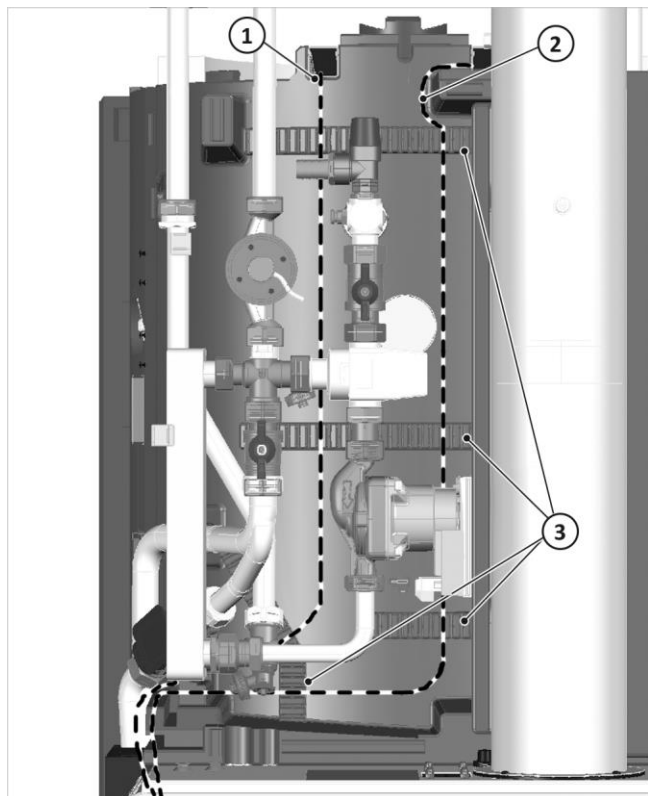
guidage de la conduite à travers l'isolation de la station d'eau chaude
